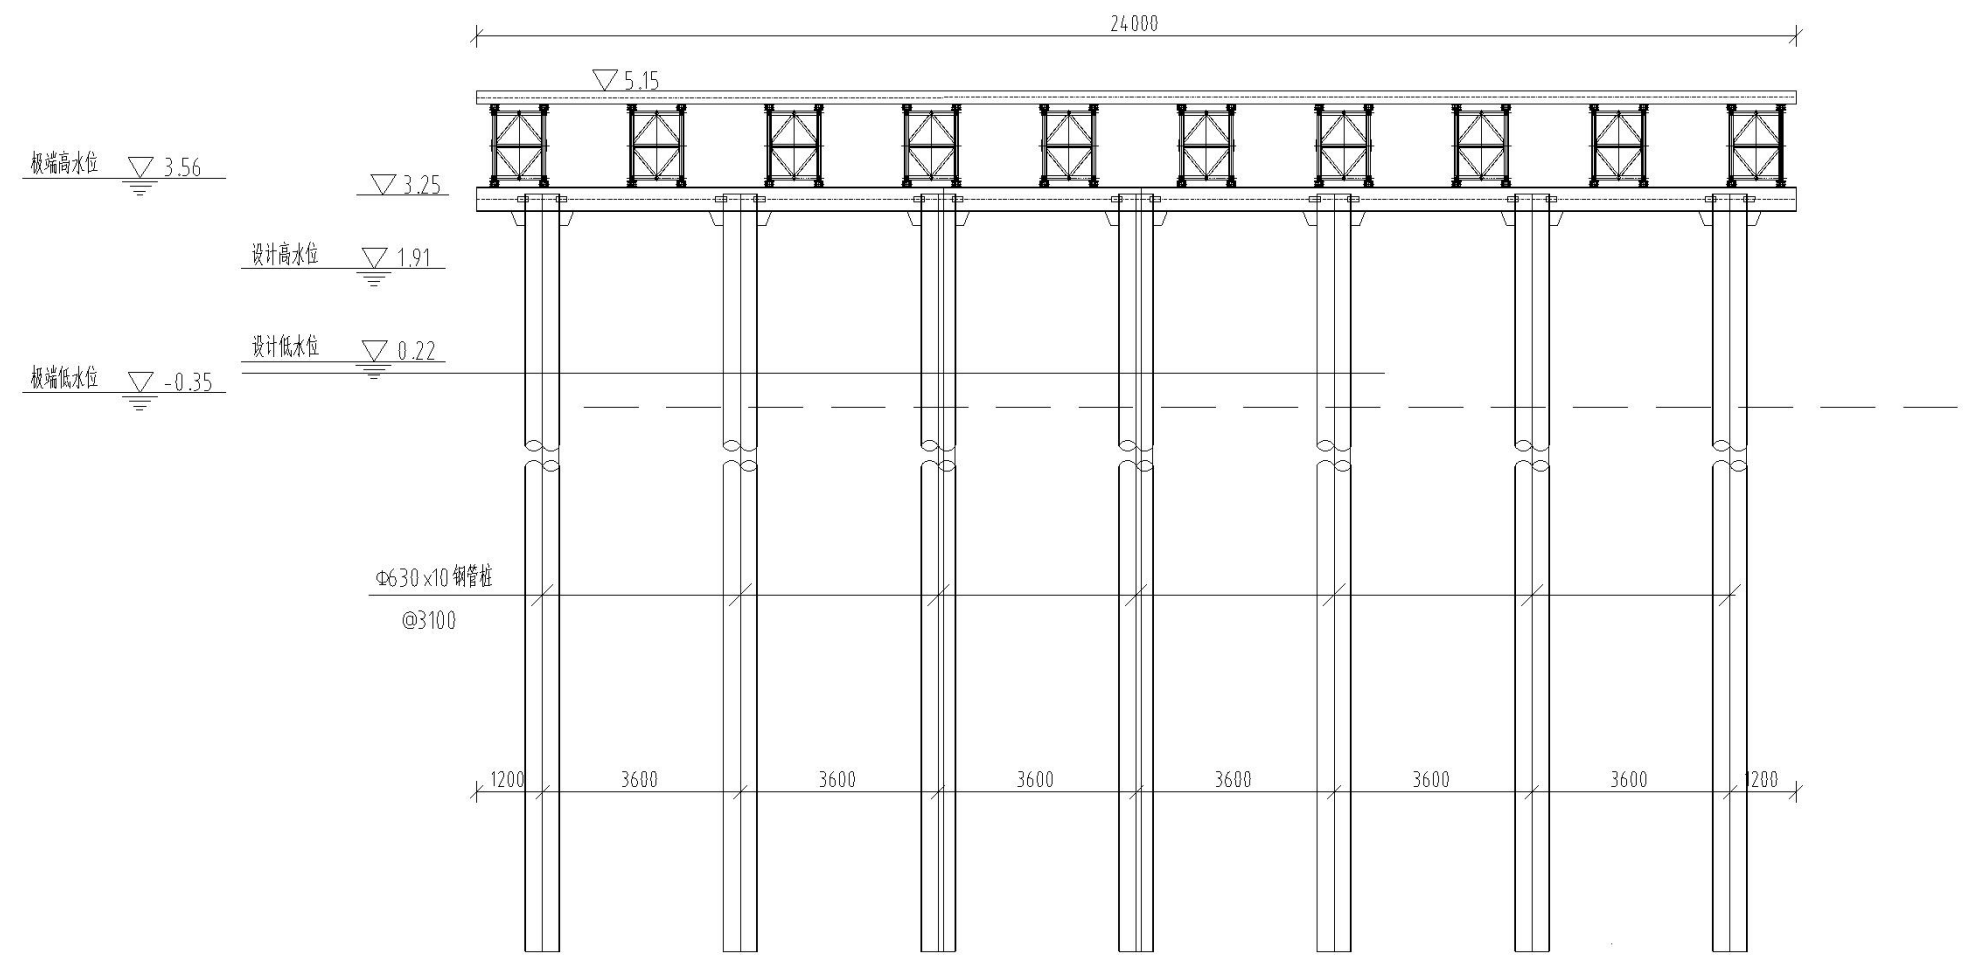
桩基施工临时平台断面图（引桥）
